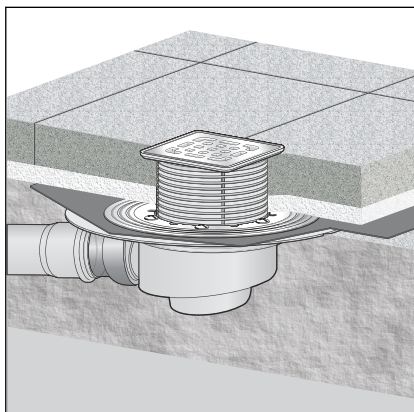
Exemplo de montagem geral – Reentrância na laje
